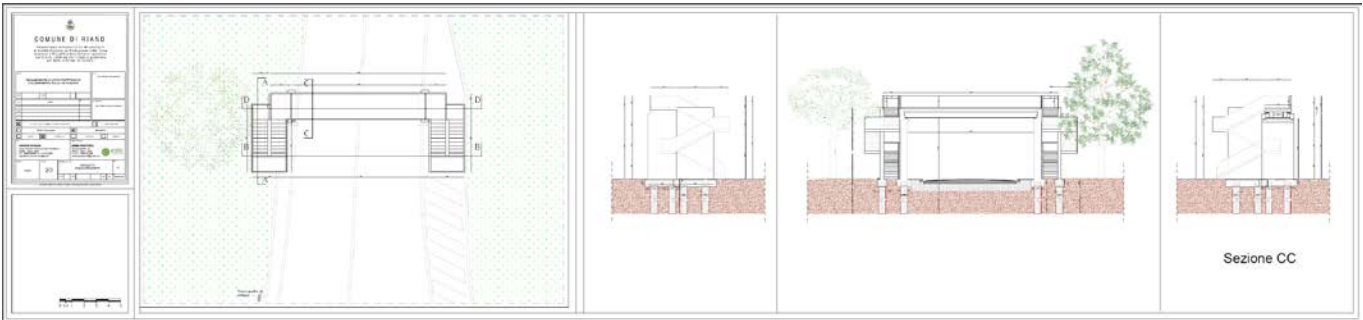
Tavola A23: pianta, prospetto e sezioni del sovrappasso.
